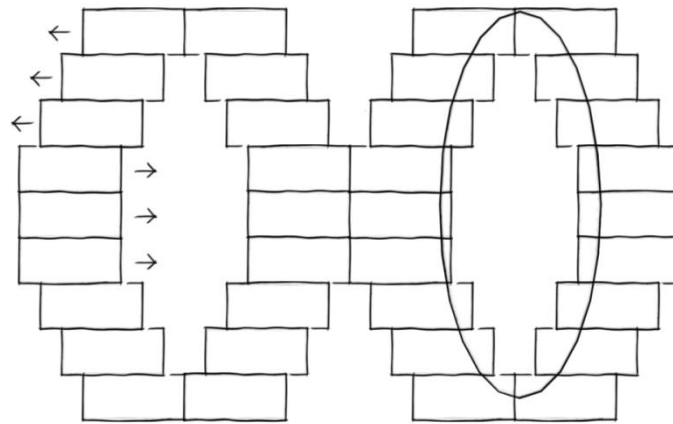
Walden 7, Ambientes Internos, Aberturas Zenitais.
